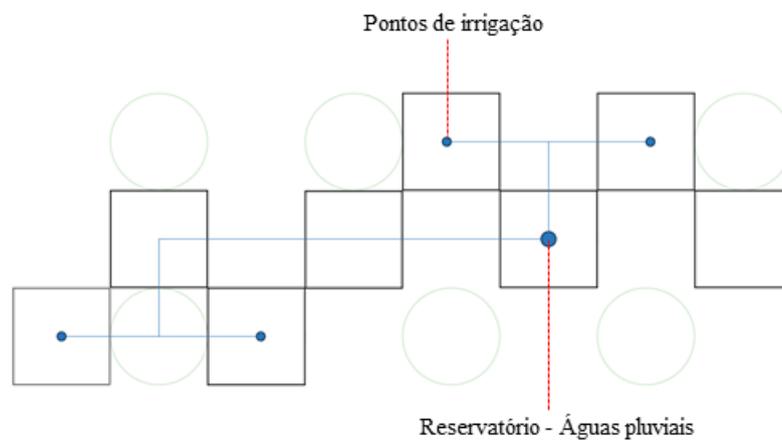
Esquema de coleta de Águas Pluviais - Planta
